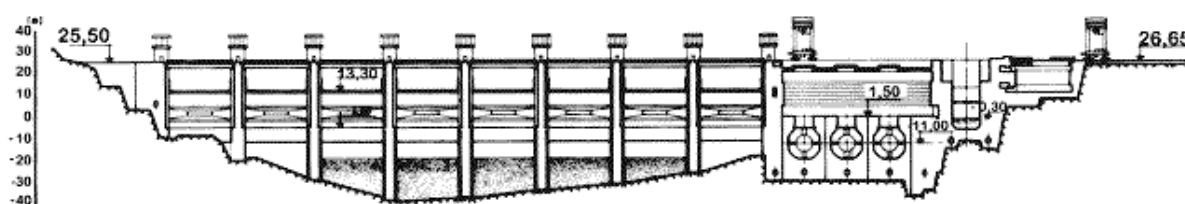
Corte longitudinal da barragem de Crestuma-Lever vista de jusante para montante [5]
